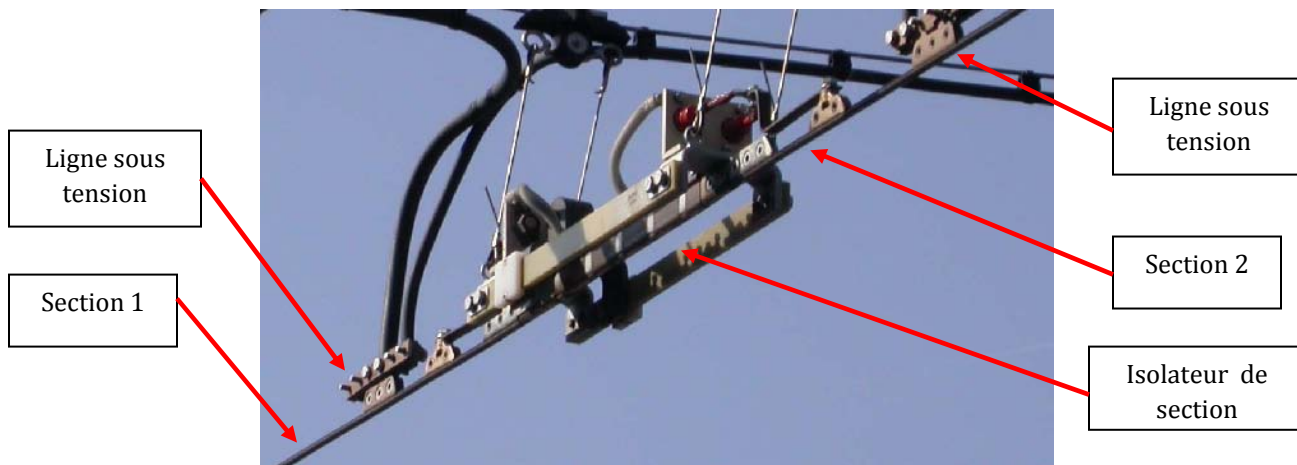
ISOLATEUR DE SECTION INSTALLE SUR LE RESEAU
